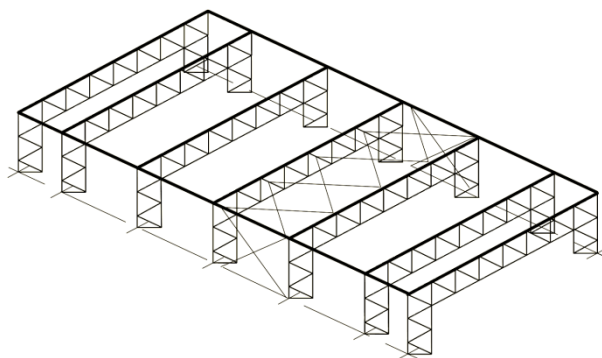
Esquema 3D de um pavilhão com pórticos treliçados (Best practice, 2008)
